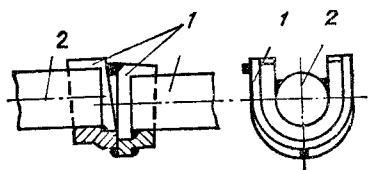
Стык стержней в сборе перед сваркой на стальных скобах
